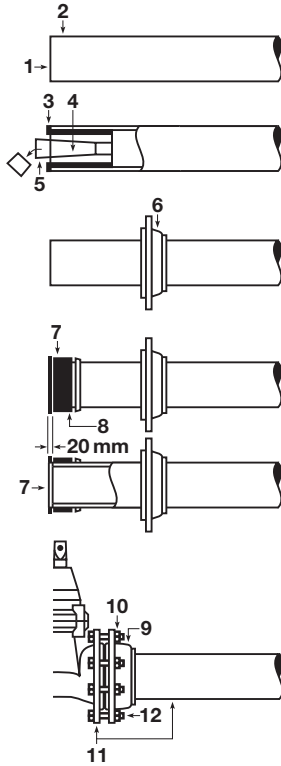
схема присоединения устойчивого к растягивающим нагрузкам свободного фланца для ПЭ труб
